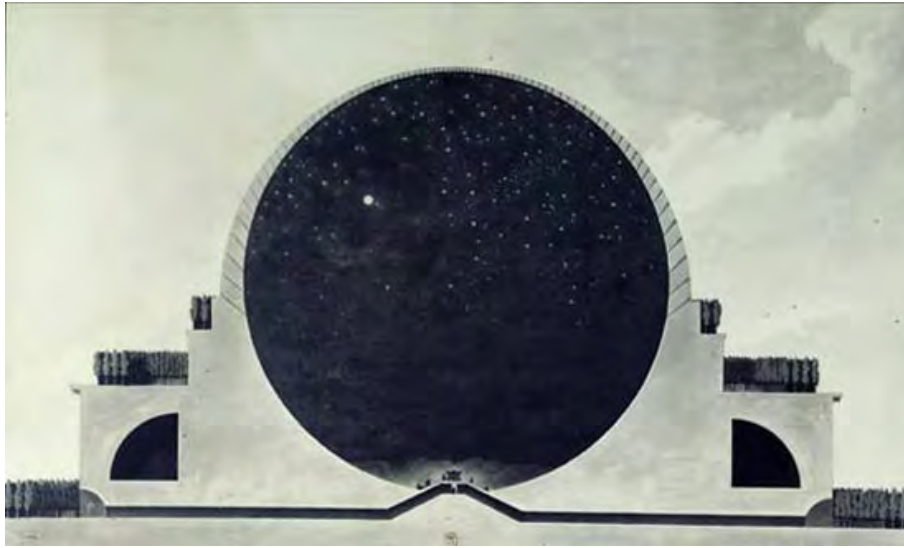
Progetto del Cenotafio di Newton dell'architetto E. L. Boullée, 1784
